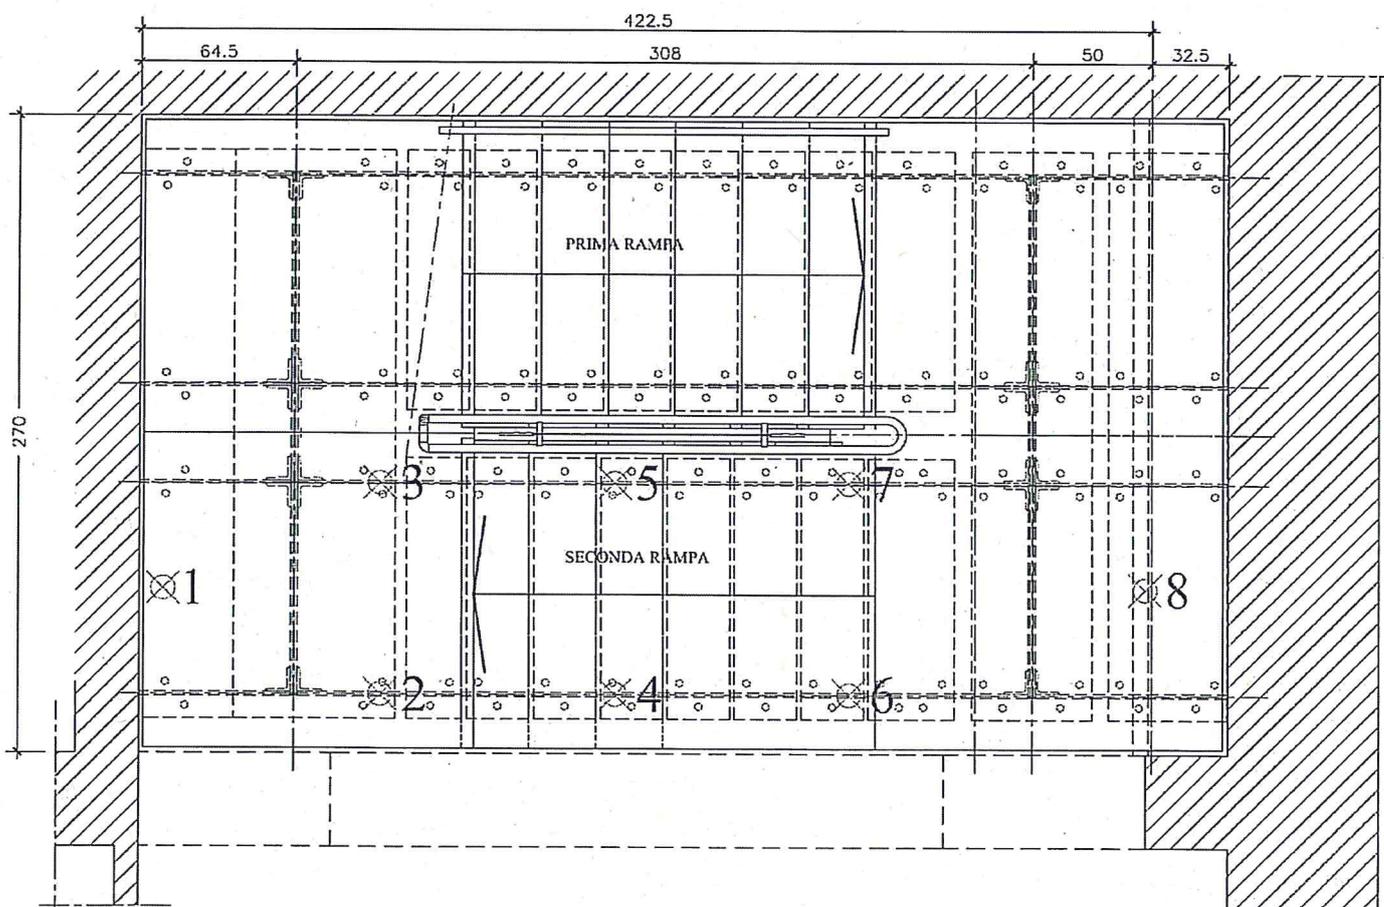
Nuova scala in acciaio - Pianta posizionamento flessimetri
